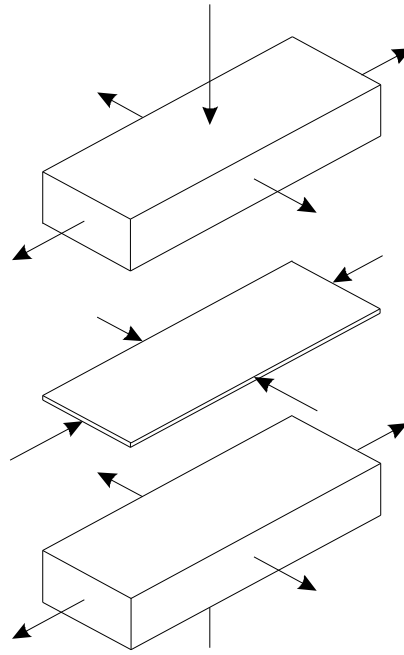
Representação esquemática das tensões nos elementos e na argamassa, numa alvenaria submetida à compressão simples, em que a argamassa é mais deformável que os elementos
